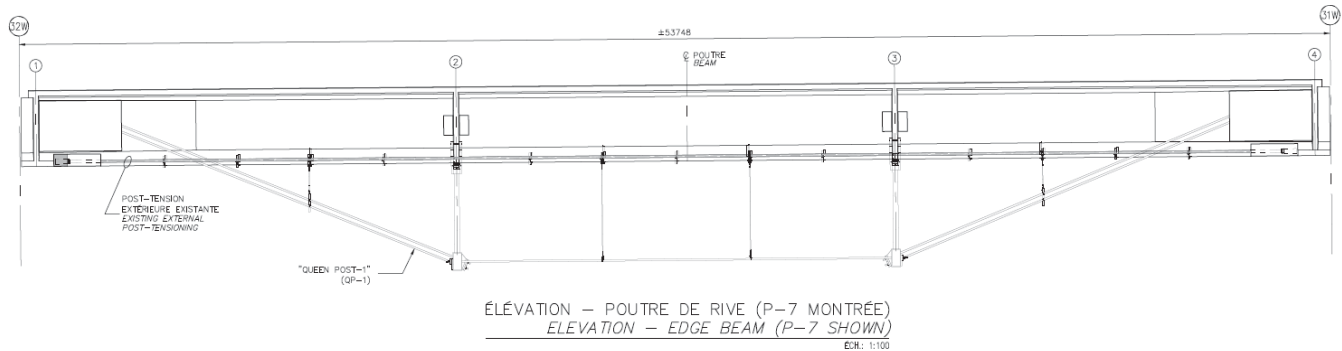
Poutres en béton – Renforcement par QP1 (source : ct 62419)
